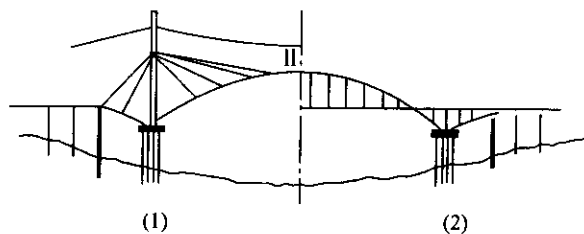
飞燕式的中承式钢管混凝土拱桥施工布置及立面
